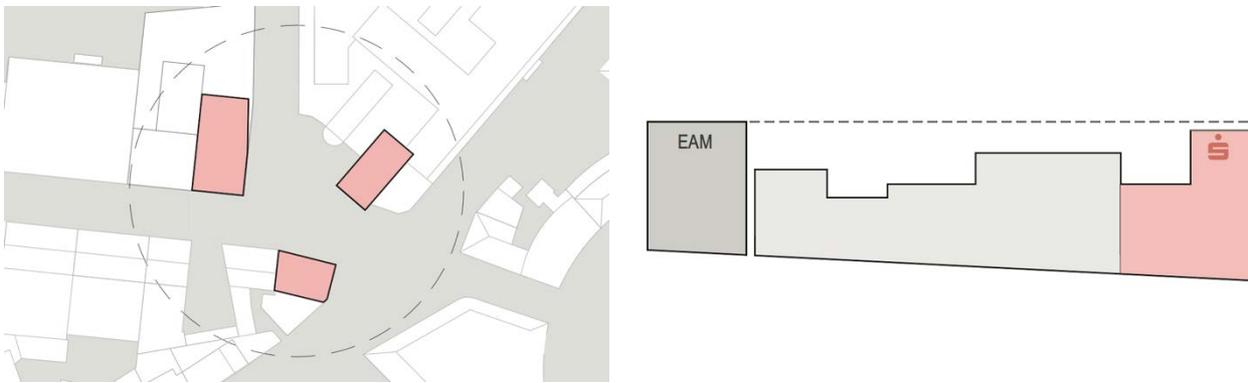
Entstehendes Gebäudeensemble im Bereich Spohrstraße/Kölnische Straße/Wolfsschlucht (links), Hochpunkte ehemaliges EAM-Hochhaus und geplanter Hochpunkt der Kasseler Sparkasse (Quelle: ATELIER 30 Architekten GmbH, Darstellung aus dem Wettbewerbsbeitrag)
